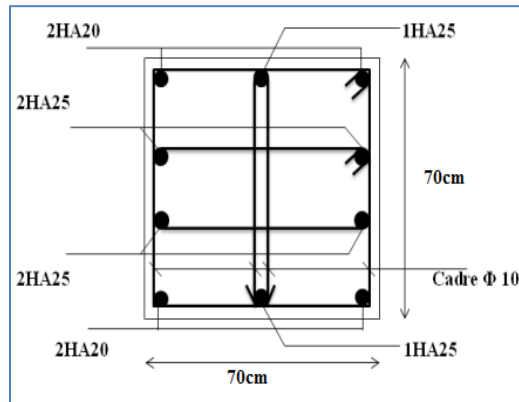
coupe de ferrailage du poteau (70×70)
